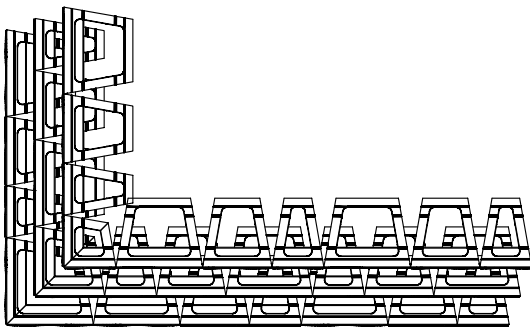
Grundriss Aussenecke mit Rücksprung 16,5 cm
